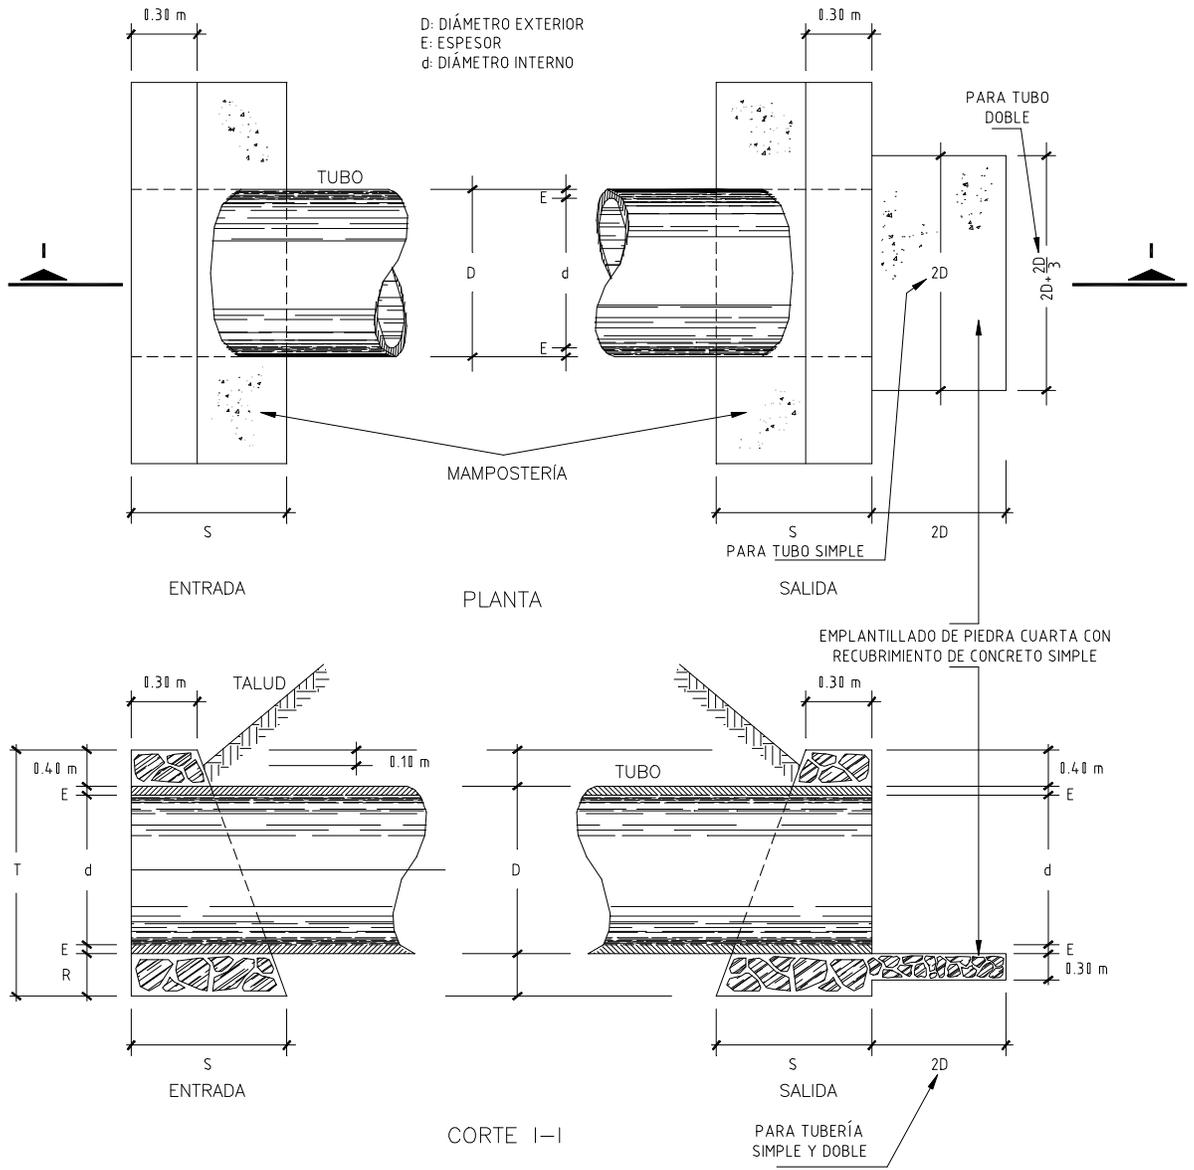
DETALLE DE CABEZAL TIPO "A" EN PLANTA Y PERFIL.
